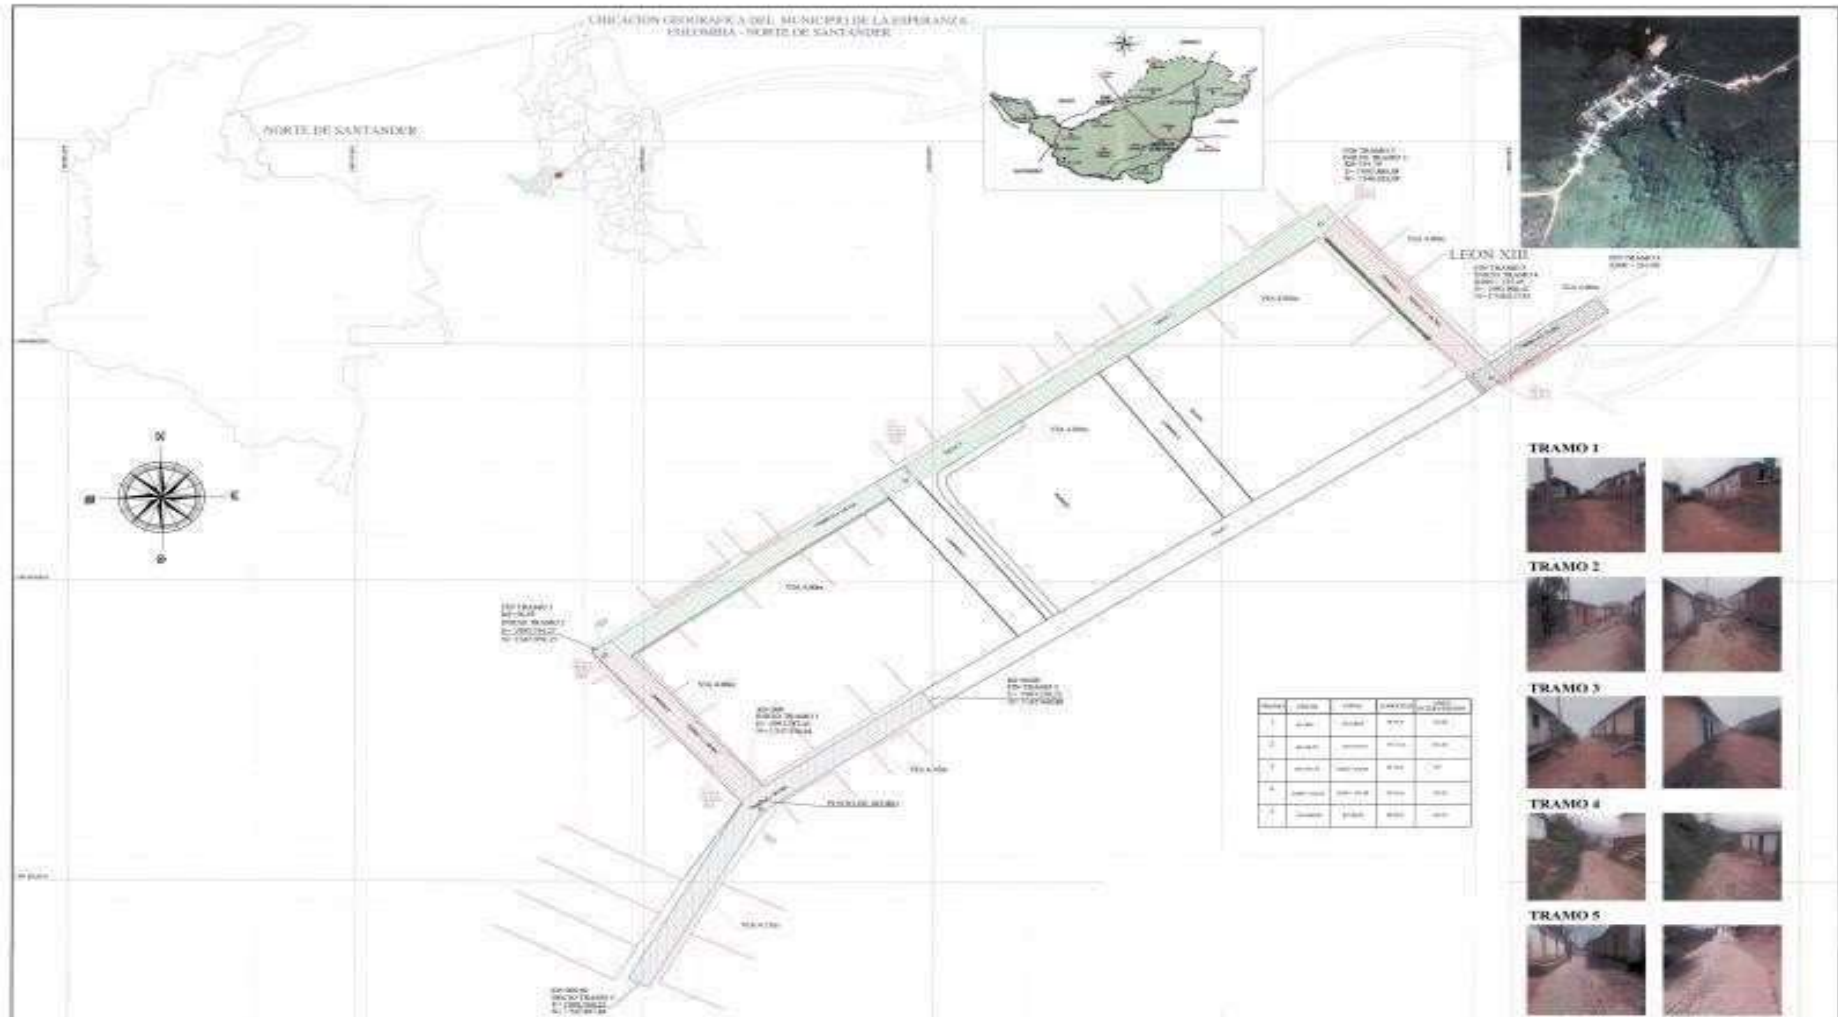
Planta arquitectónica de construcción de vías urbanas de pavimento rígido. Fuente: Secretaria de planeación de la alcaldía de la esperanza N.S.
